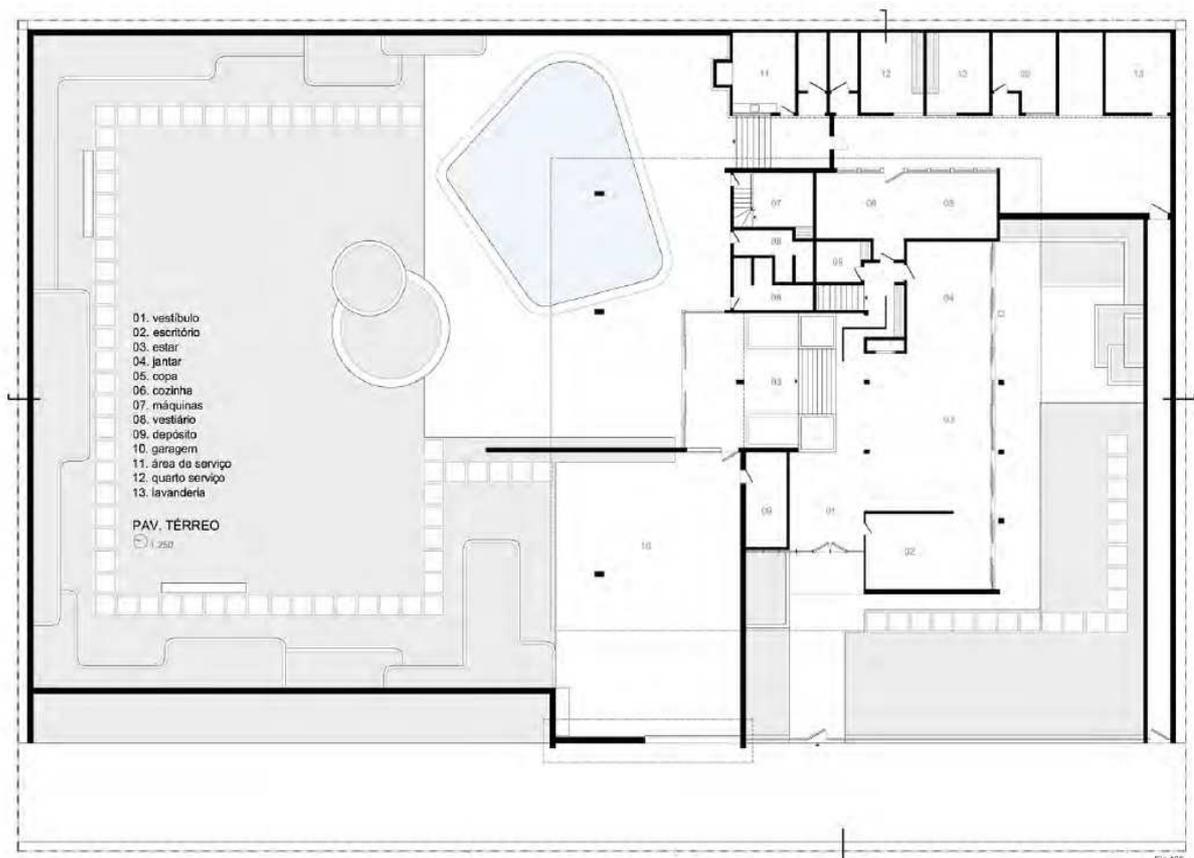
| PLANTA BAIXA TÉRREO CASA ABDALA ABRÃO, 1967 – ARQUITETO DAVID LIBESKIND. S SILVA NETO, 2010, P. 117.
